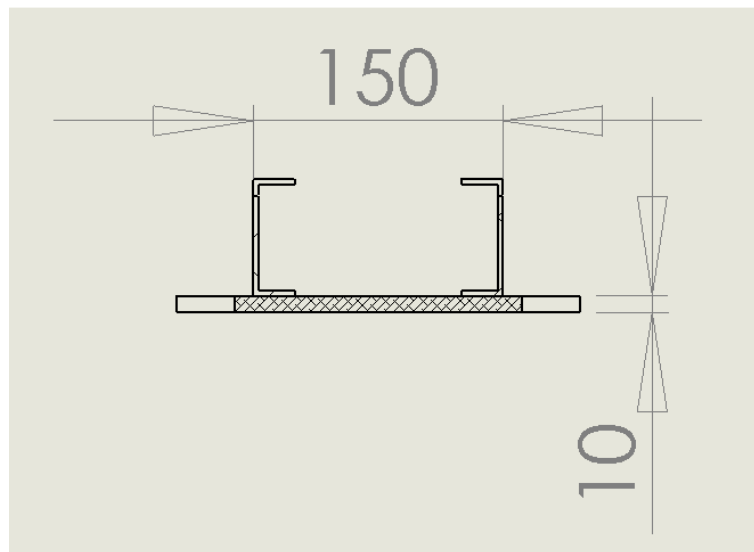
sección transversal de la viga compuesta(base+perfil)
